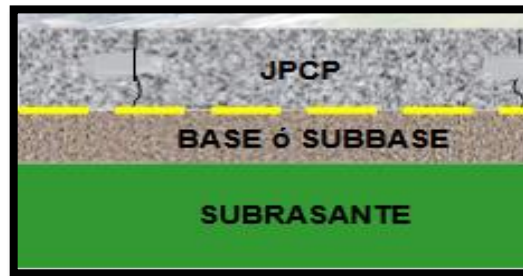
Pavimento de Concreto Simple sin Dovela (JPCP).
